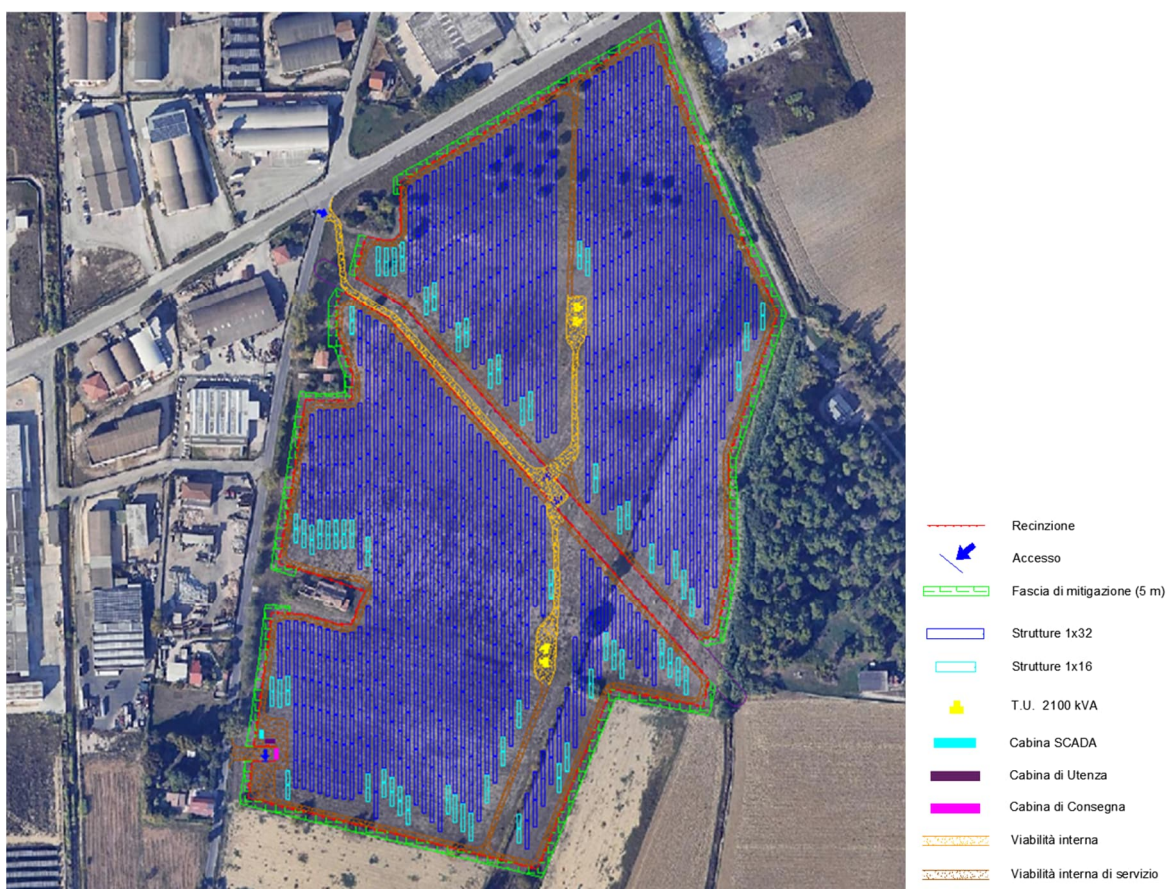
Sovrapposizione su ortofoto del layout di progetto (Fonte: Google Earth)
